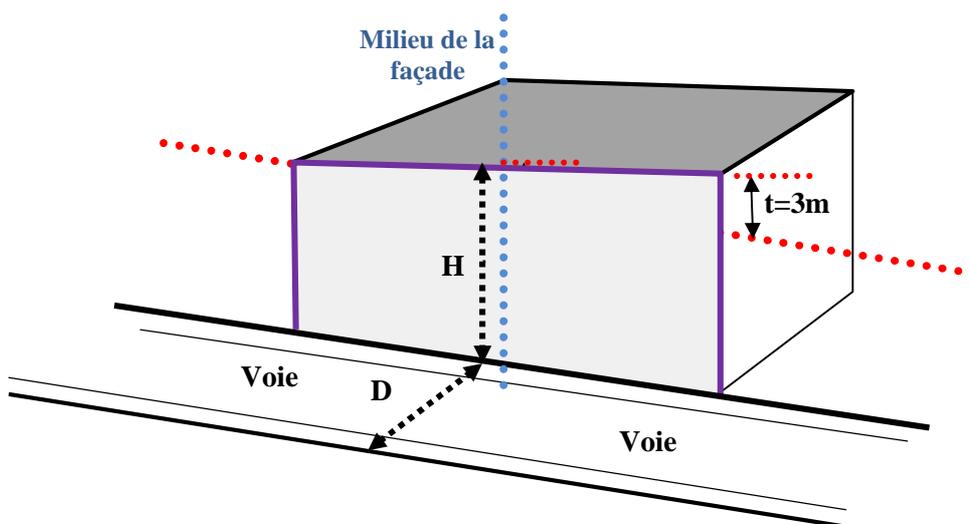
Coupe définissant la tolérance sur la hauteur d'une construction en bordure d'une voie en pente. Source : Auteur, 2014
